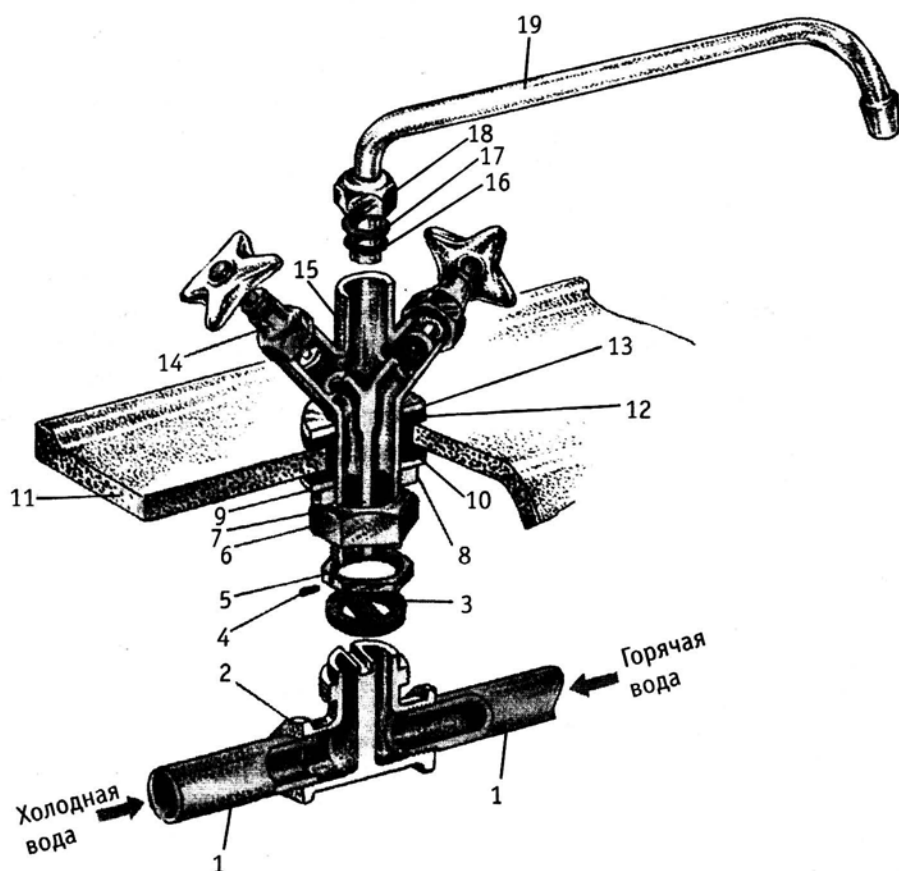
Смеситель настольный центральный с верхней камерой смешивания (смеситель типа «Елочка» с накидной гайкой и тройником):
